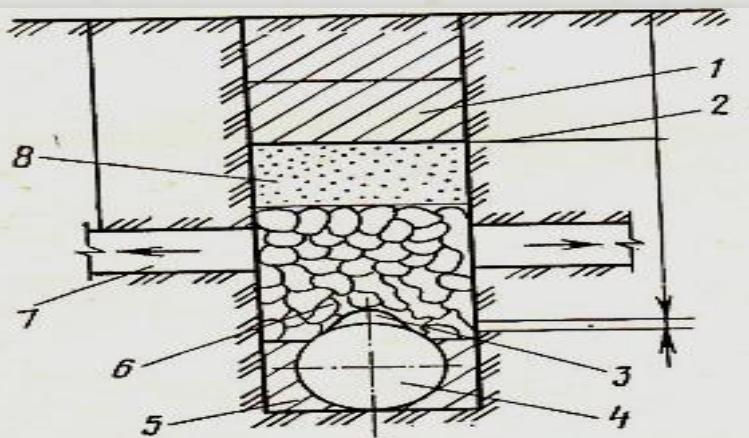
Поперечный разрез траншеи с оросительным трубопроводом:
